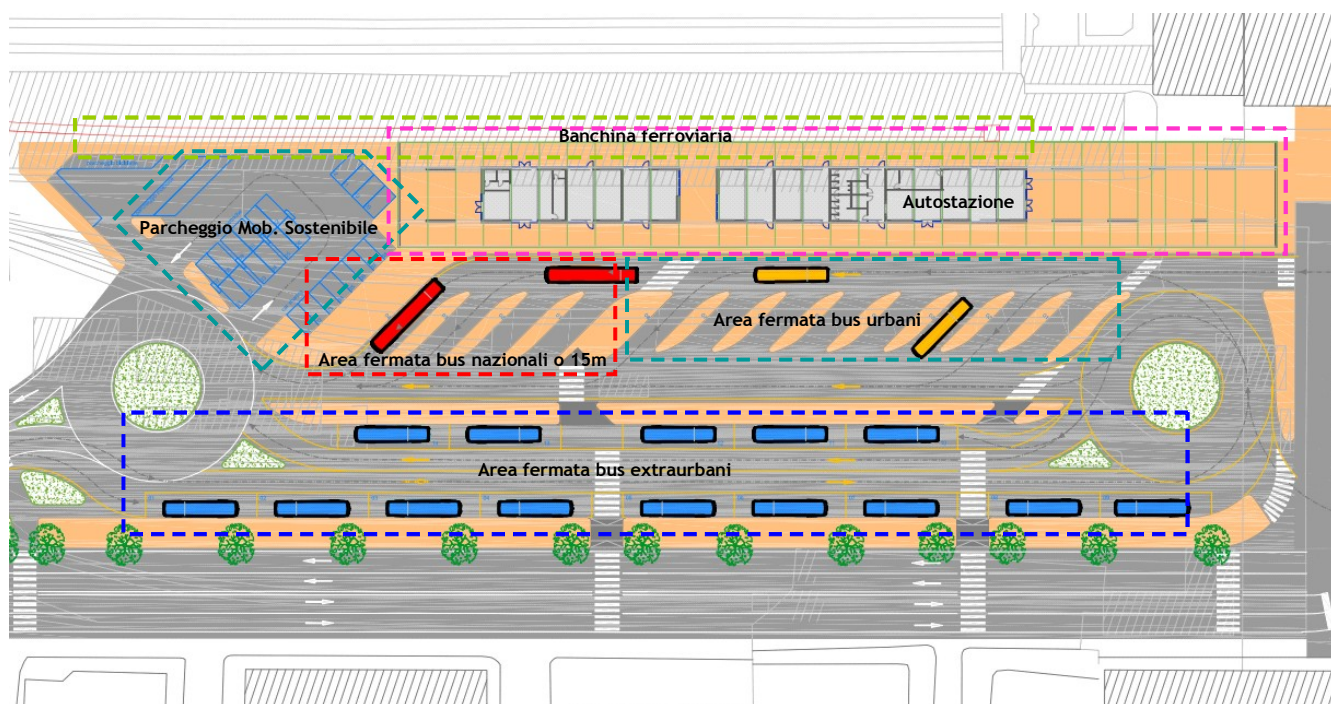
Planimetria Terminal Intermodale e Aree di Fermata
